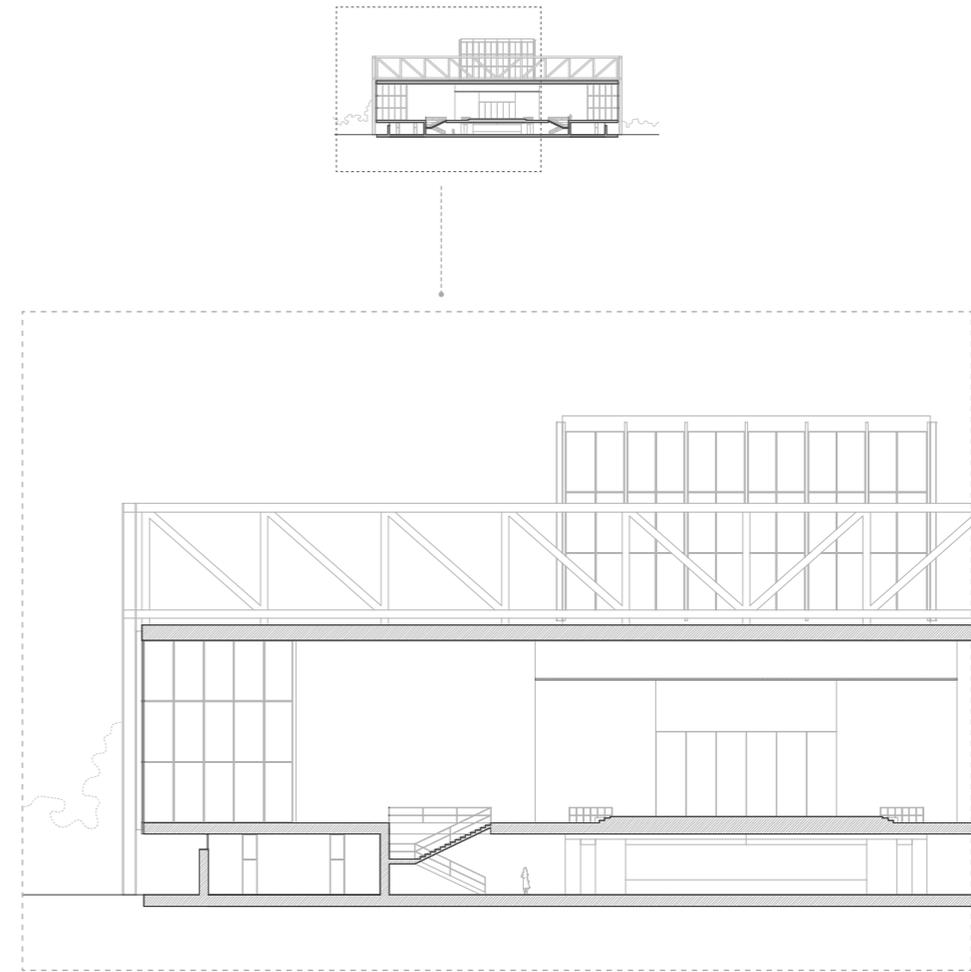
Detalle de la axonometría seccionada por el hall de entrada.
